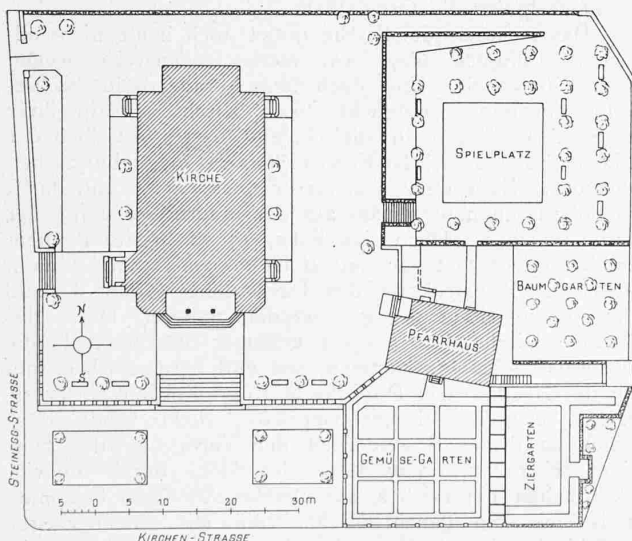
Lageplan von Kirche und Pfarrhaus. — 1:1000.
